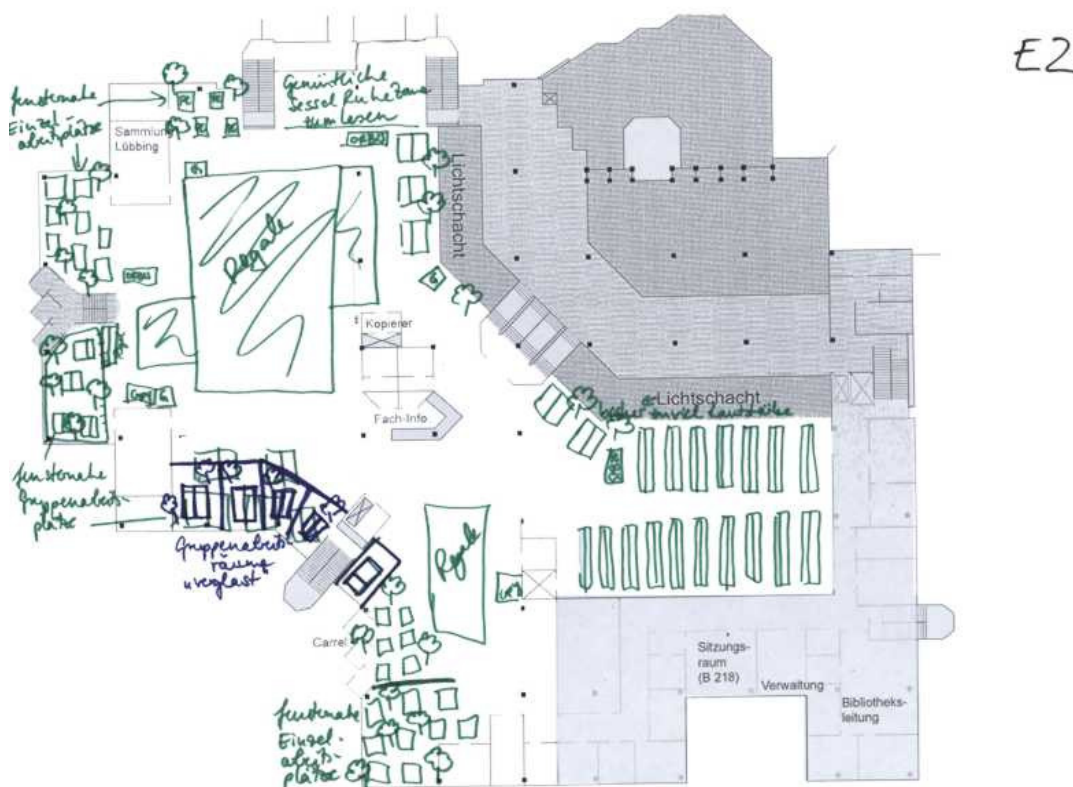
Grundriss der Ebene 2 (Sandra)
